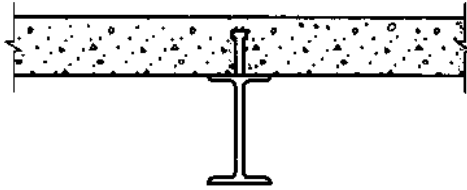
工字形截面钢-混凝土组合梁示意图
